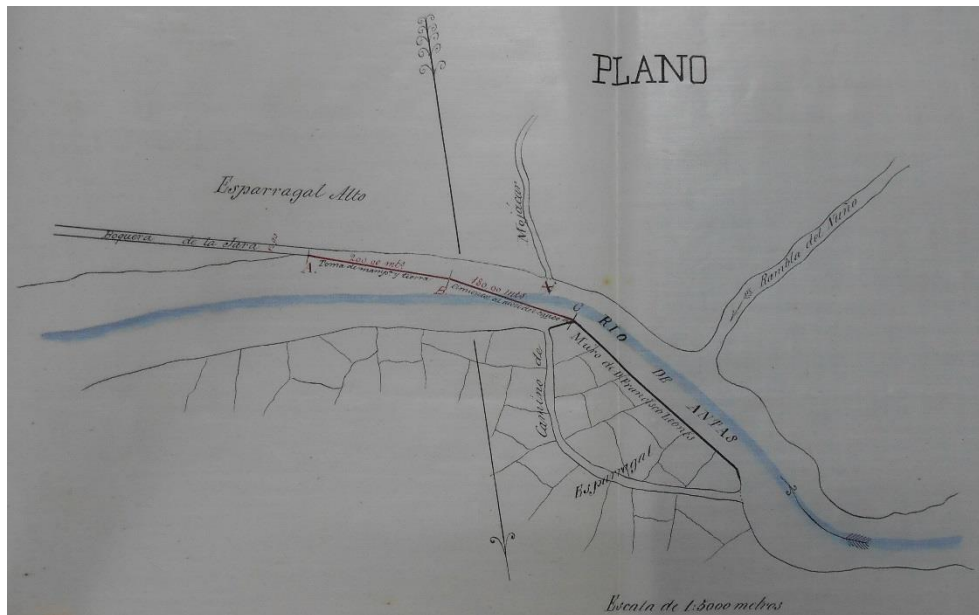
Plano de detalle del tramo de la Presa de La Jara.
